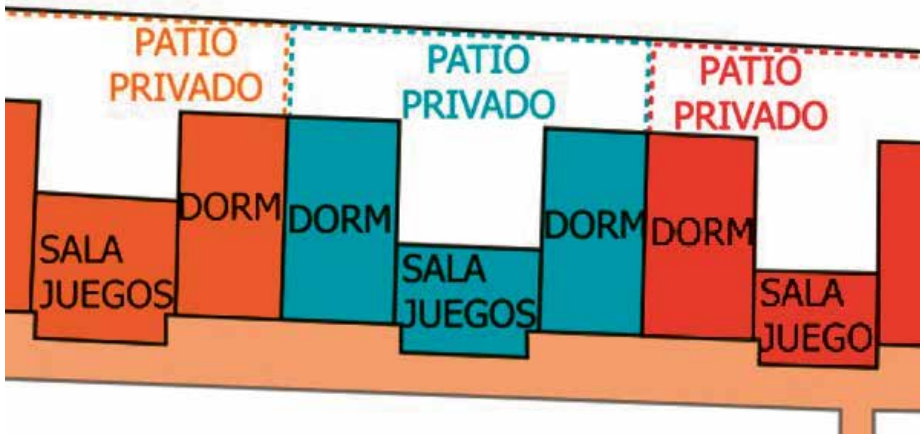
Esquemas planta general y planta habitaciones . Fuente: elaboración propia.
